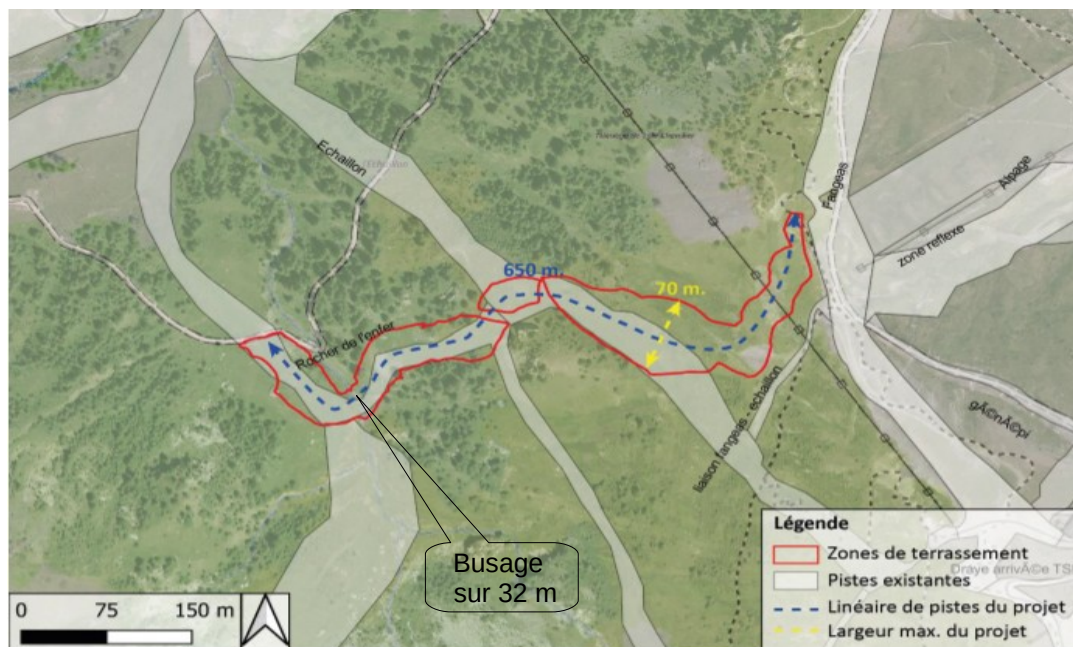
Plan de situation des travaux - Source étude d'impact.
